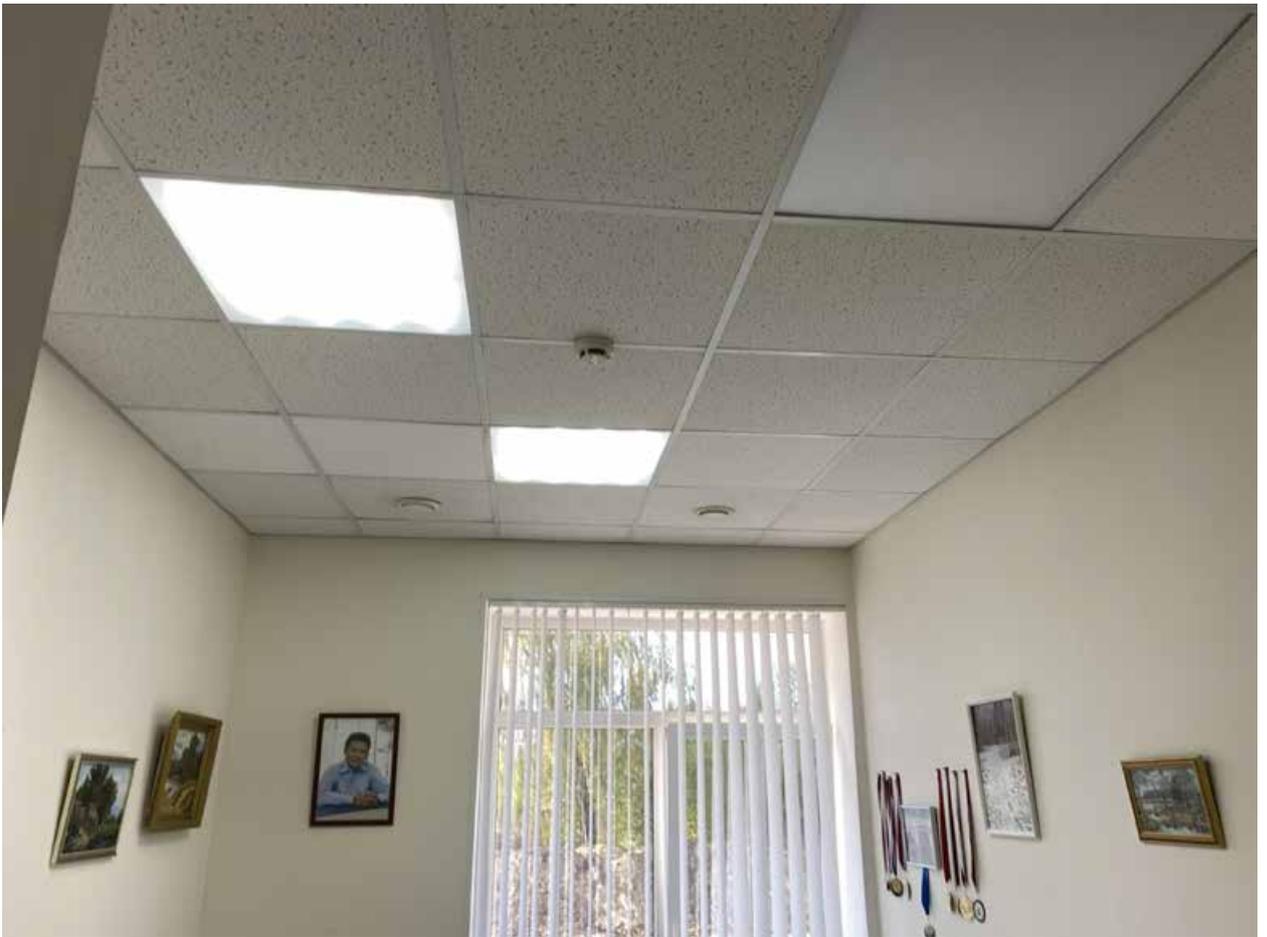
1 этаж. Помещение 2-Н(87,88).
